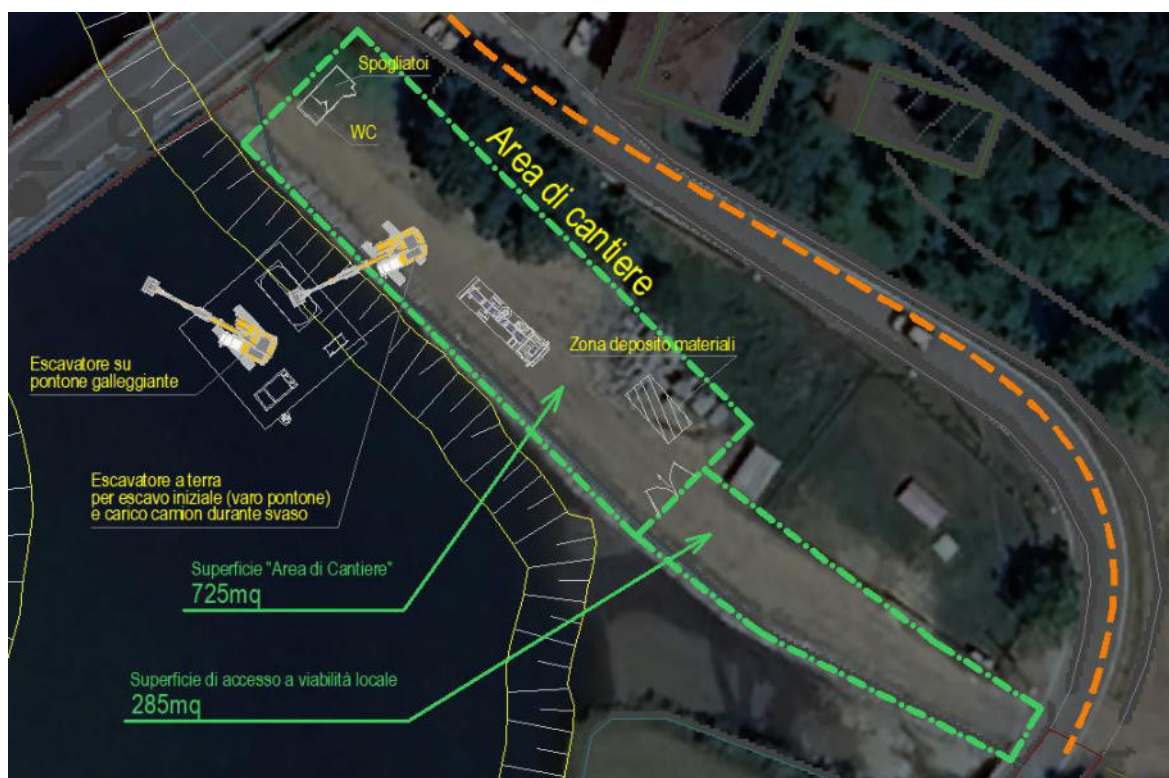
Occupazione dell'area di cantiere e dell'area di collegamento con al viabilità locale
